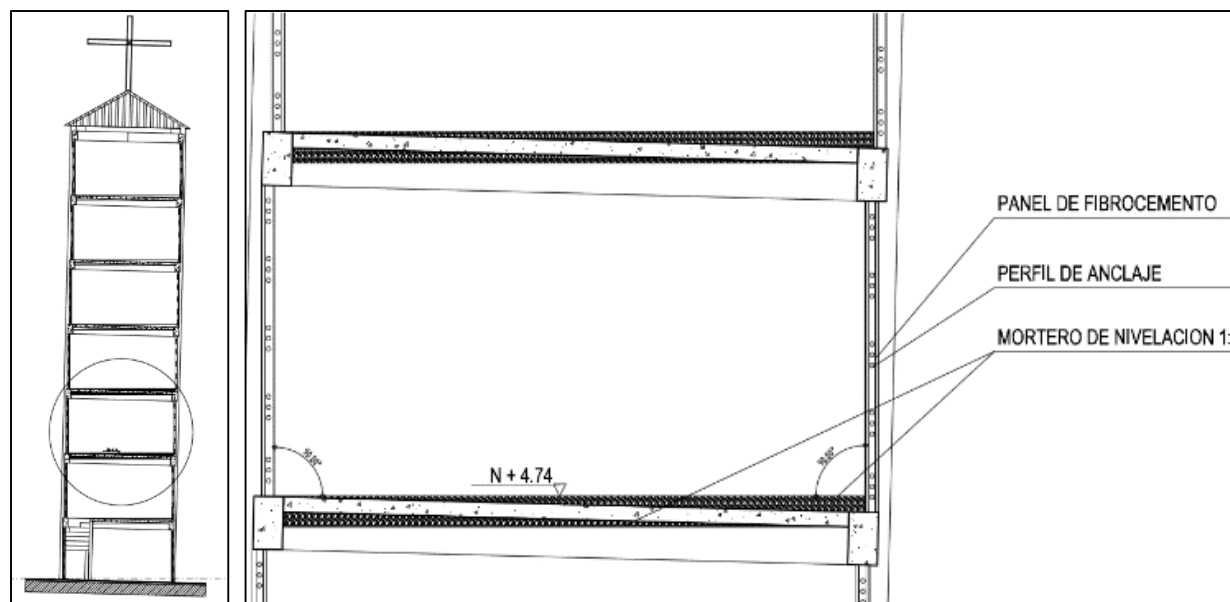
Detalle de nivelación de entrepiso y fachadas.
